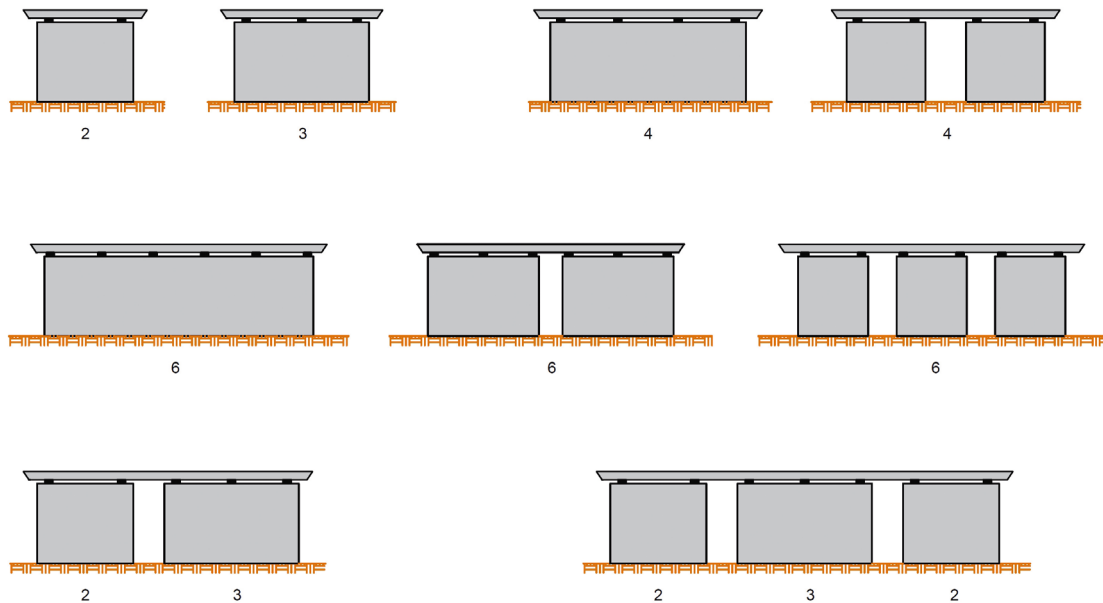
Utilisation de voiles pour les piles intermédiaires.
